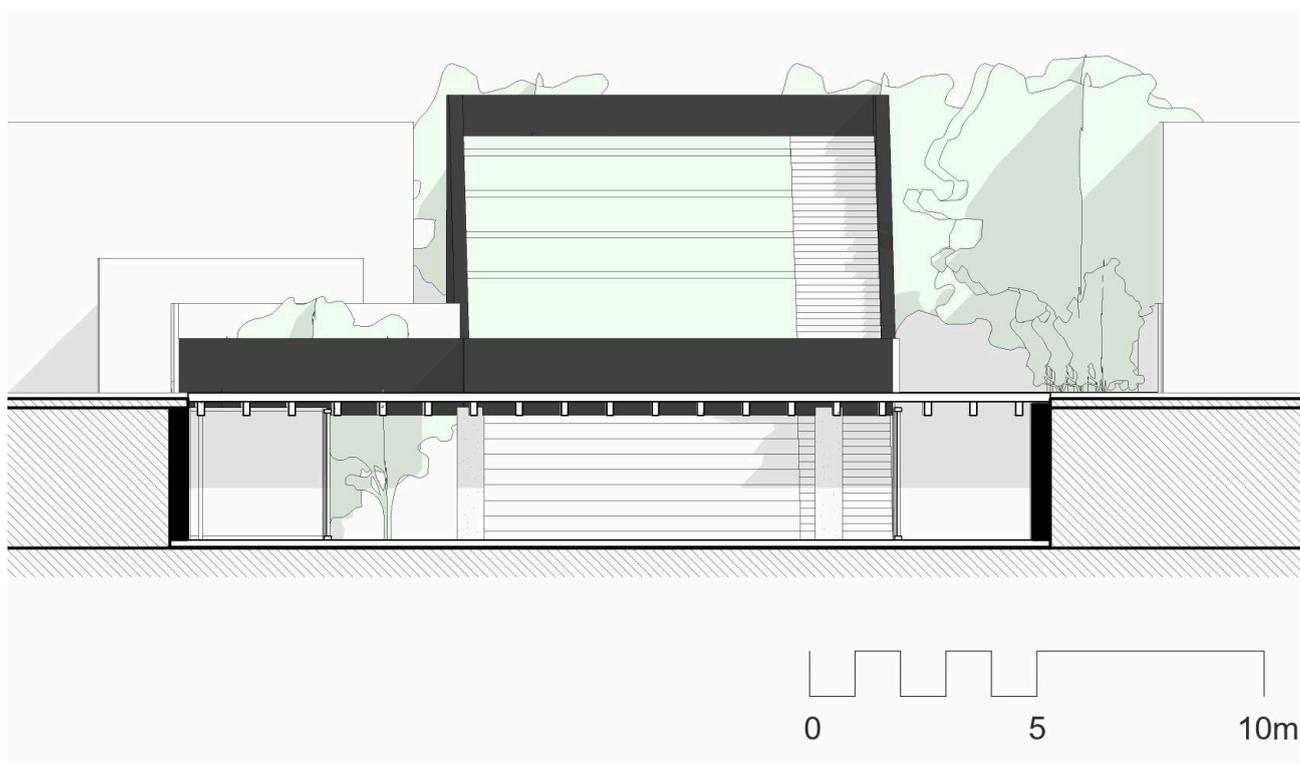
Elevación fachada sur terreno (2) calle Catedral . Fuente: Elaboración propia.
